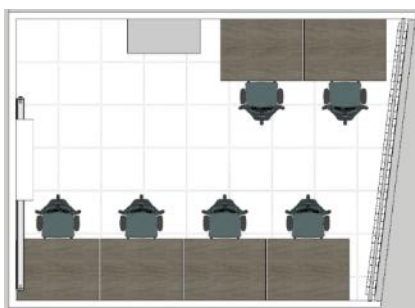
Detail Tampak Atas Meja Alternatif Desain 2
